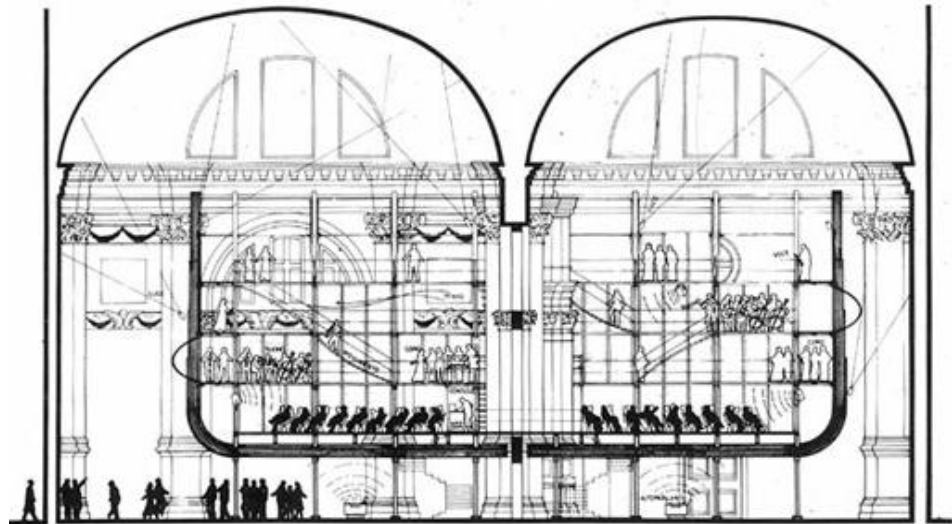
Piano, sezione del progetto per il "Prometeo"
